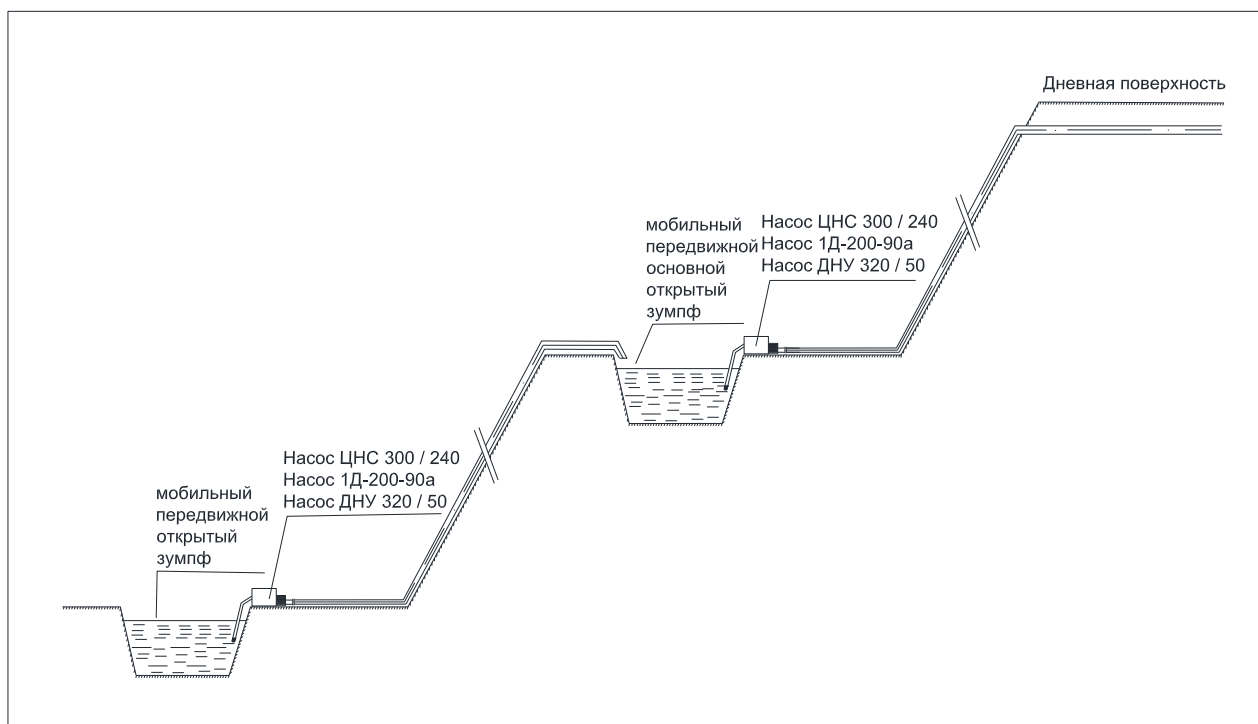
Схемы устройства карьерного водоотлива
